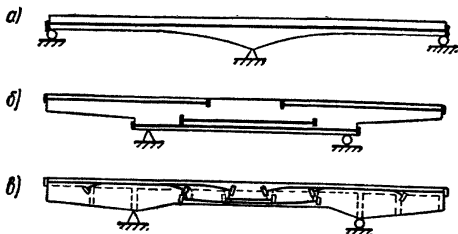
Примерные схемы армирования предварительно напряженных неразрезной и консольных балок
